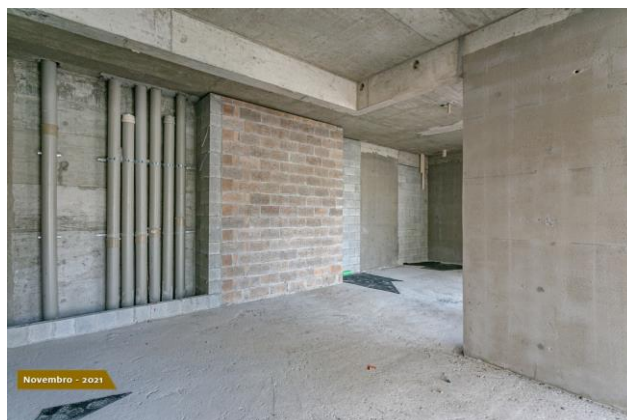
Alvenaria em pavimento finalizada com detalhe para tubulação hidráulica
